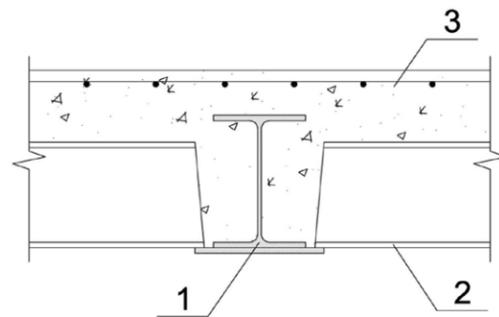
Монолитное перекрытие с омоноличиванием стальной балки. 1- балка; 2 - второстепенная балка; 3 - бетон
